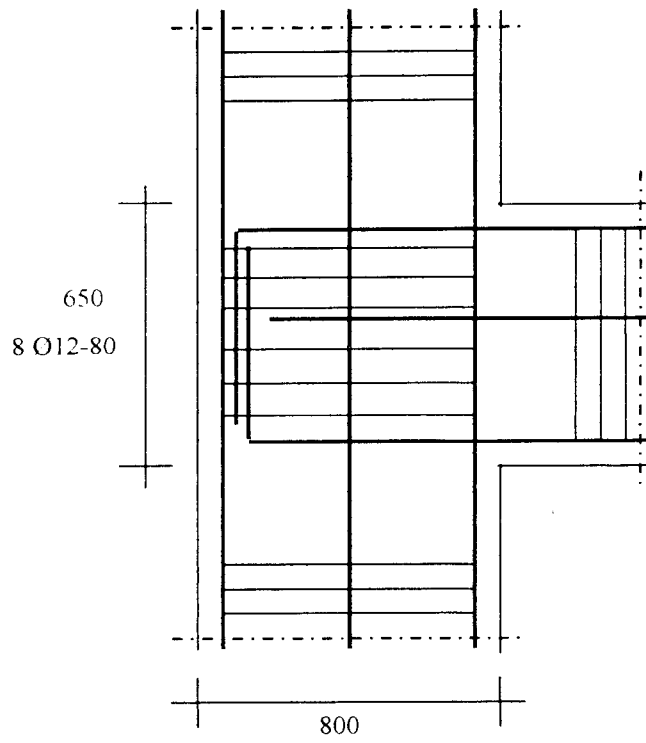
Detail join Balok Kolom D Lantai 10 dan 11
